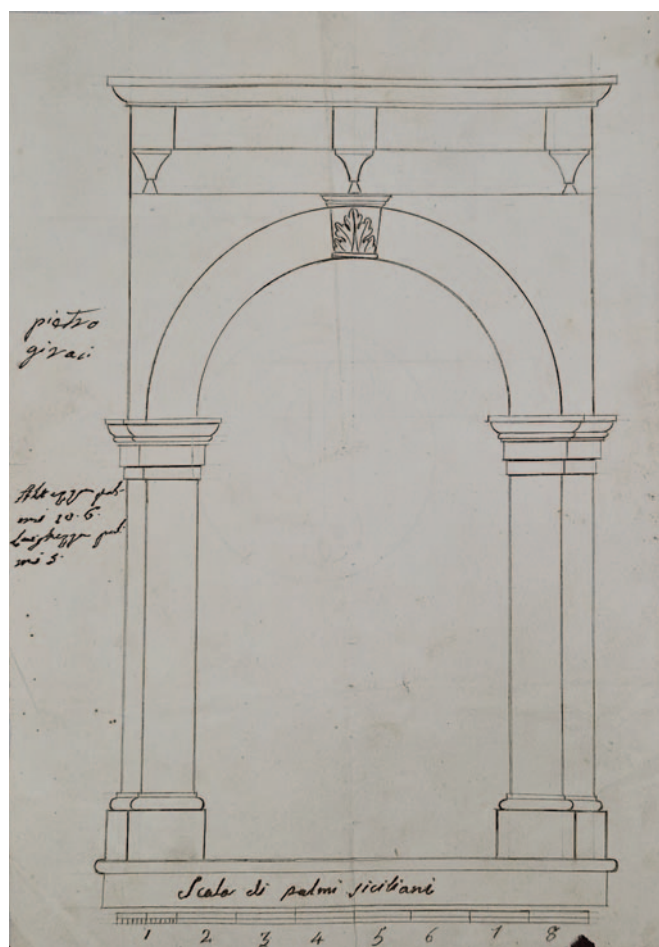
Progetto di un portale, prospetto (Adrano, Archivio della Collegiata, carpetta Chiesa Madre. Campanile. Disegni).
